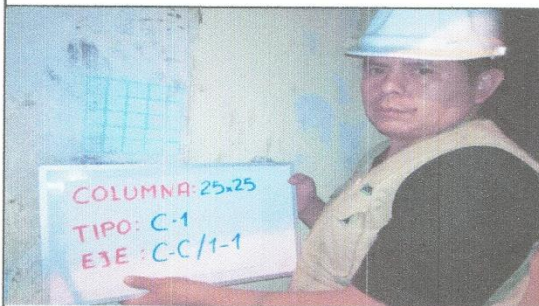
Columna ubicado en el 1er piso Eje C-C/1-1
